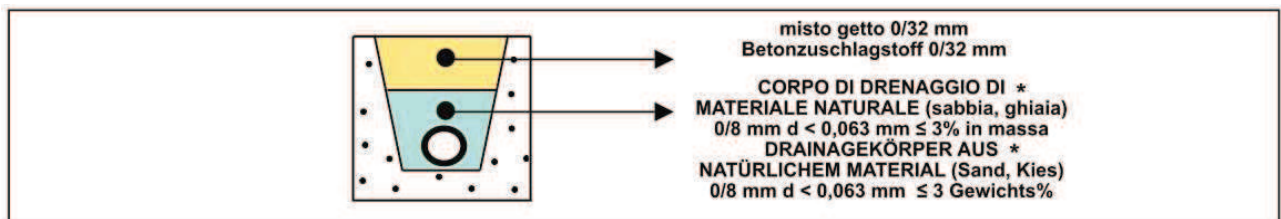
Auffüllungen und Drainagen (A Straßenbauwerke und B Gebäude):
